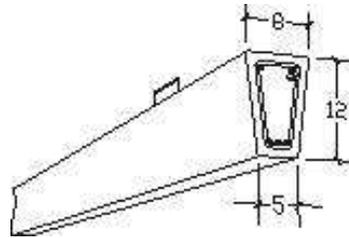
Armado de viga trapezoidal (Tekla User Assistance, 2013)
